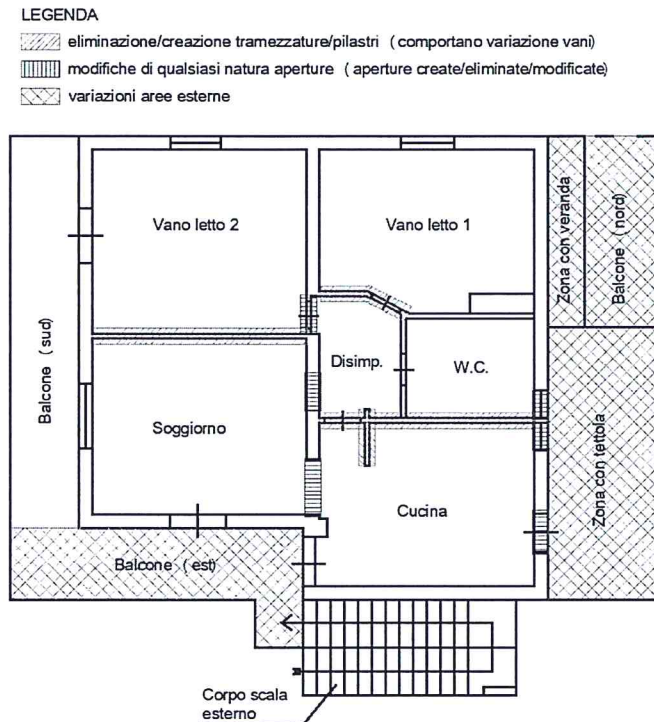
Pianta piano primo – difformità immobile rispetto planimetria catastale
